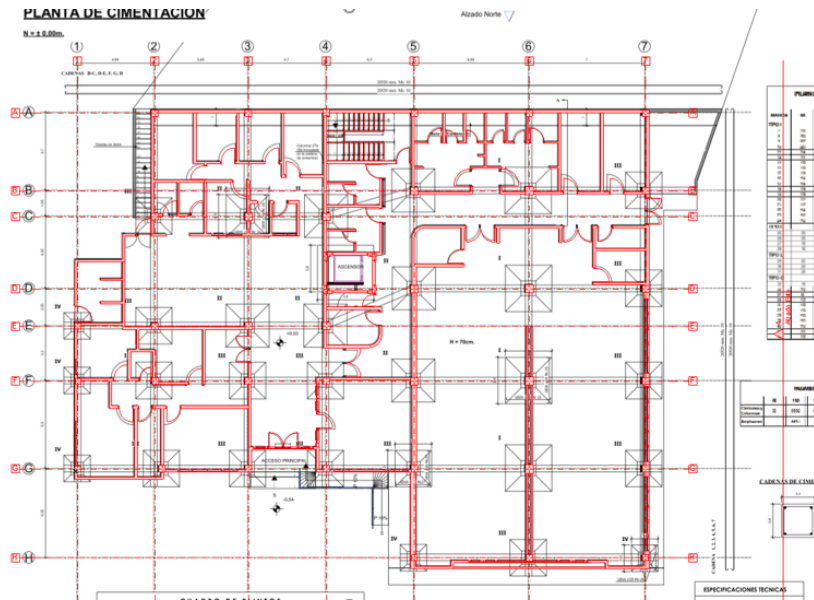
Referencia activada planta de cimentación. Elaboración: Del autor.
